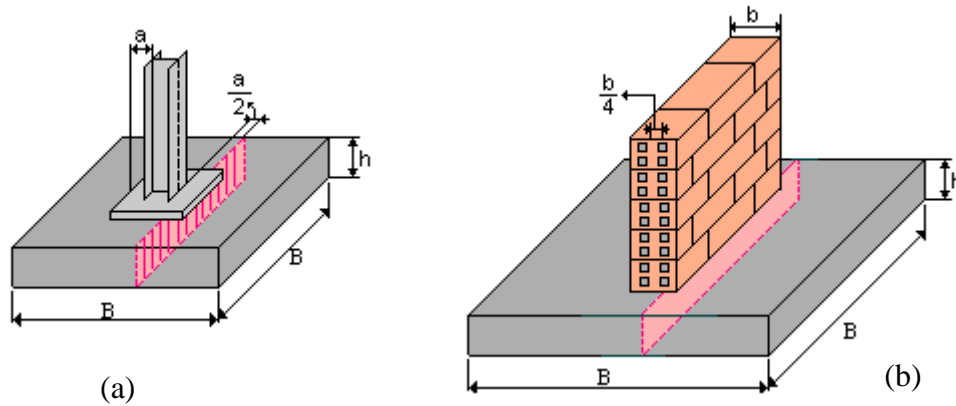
Sección Crítica para el Cálculo del Momento en Zapata que Soporta Columna Metálica (a) y Muro de Mampostería Estructural (b).
